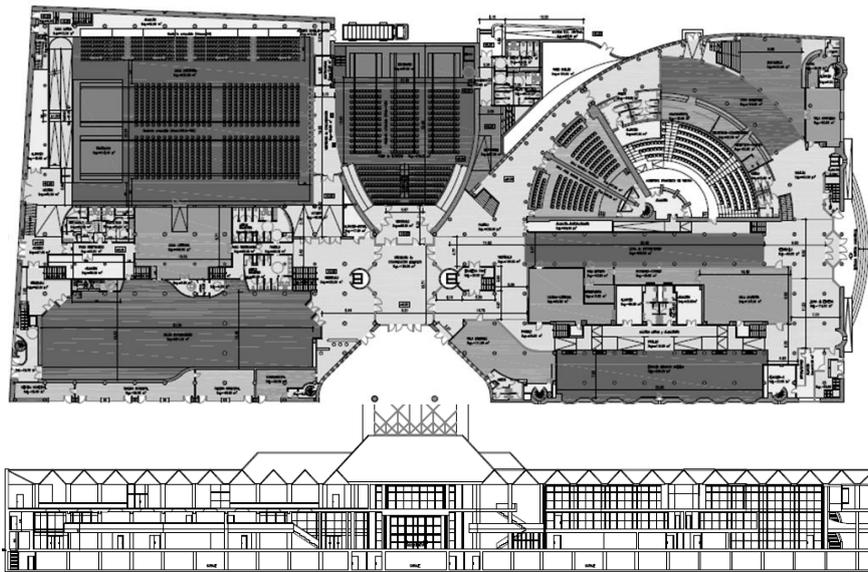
Planta baja y alzado principal del Palacio de Congresos Europa, de Vitoria-Gasteiz
